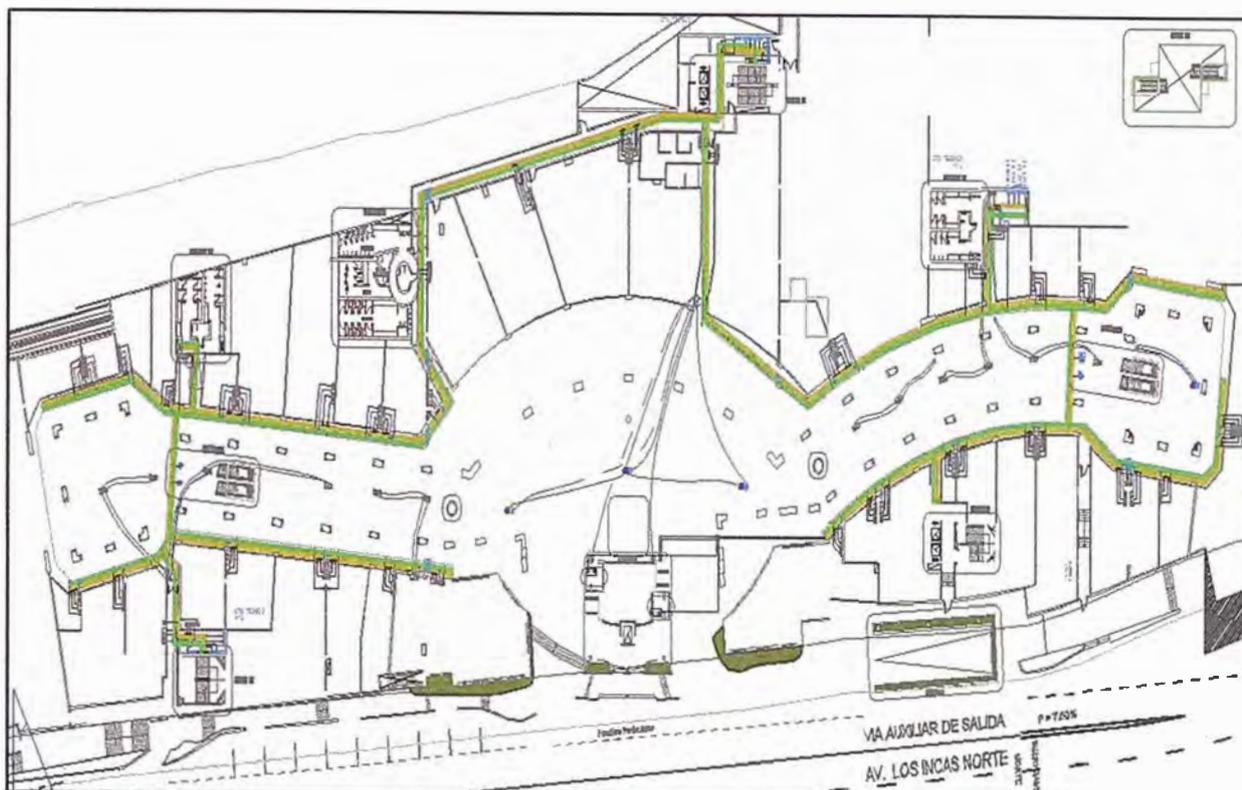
Plano de la primera planta del C.C. Comercial Parque Lambramani. Fuente: Elaboración propia.
